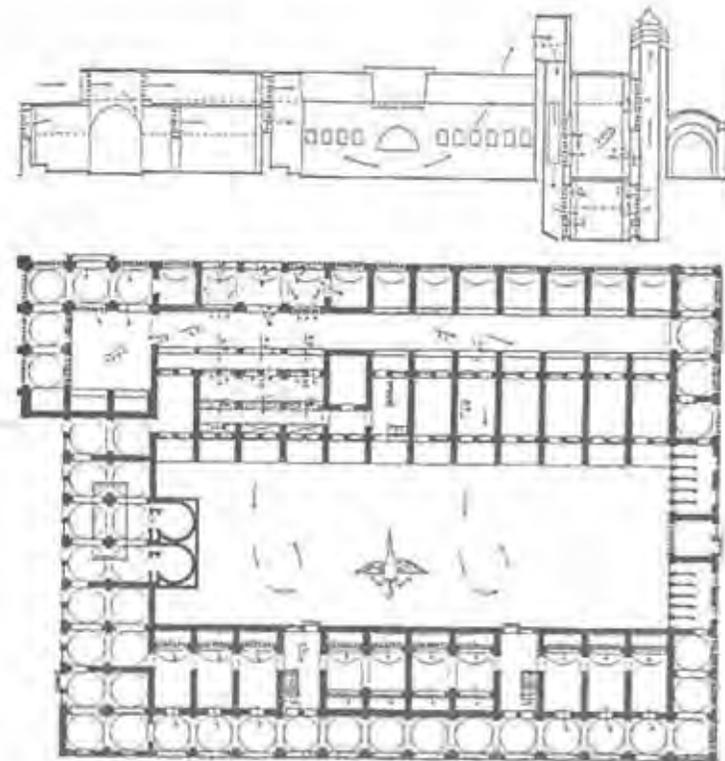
Grundriß und Schnitt durch den Markt in Kharga zeigt den Malqaf und Windauslaß im Keller
